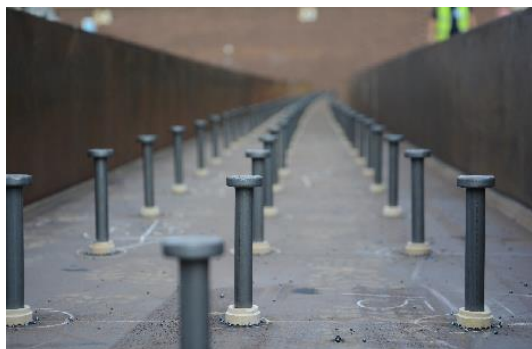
Viga mista com sistema de fôrma metálica incorporada
